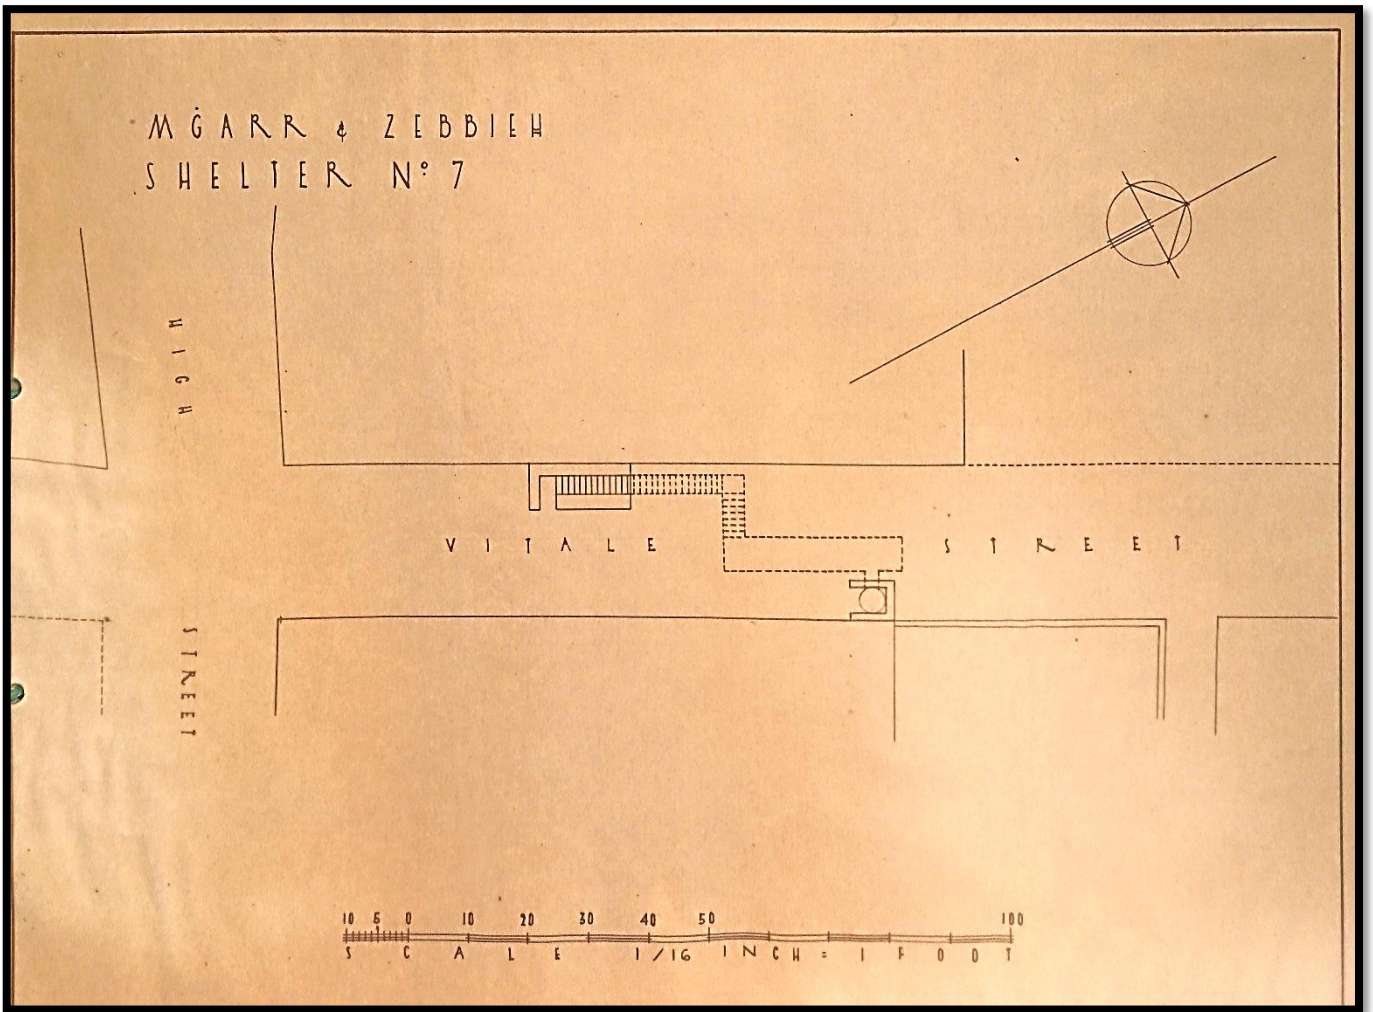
Planta do Abrigo nº7 "High Street – Vitale Street."
